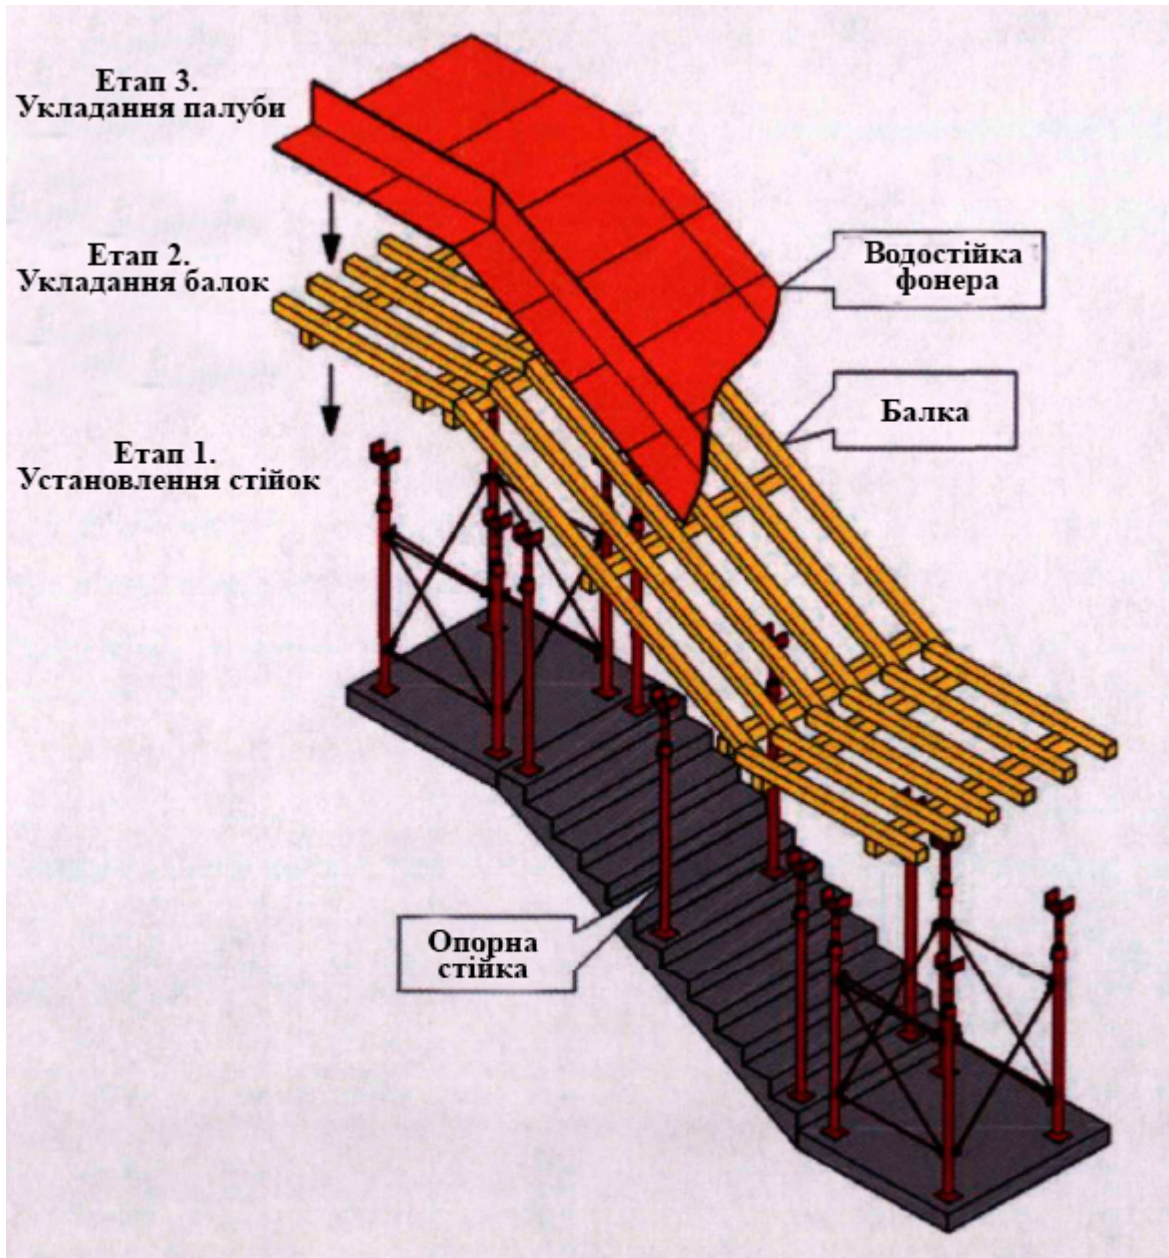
Установка індивідуальної опалубки для сходового маршу і майданчиків на монтажну позначку
